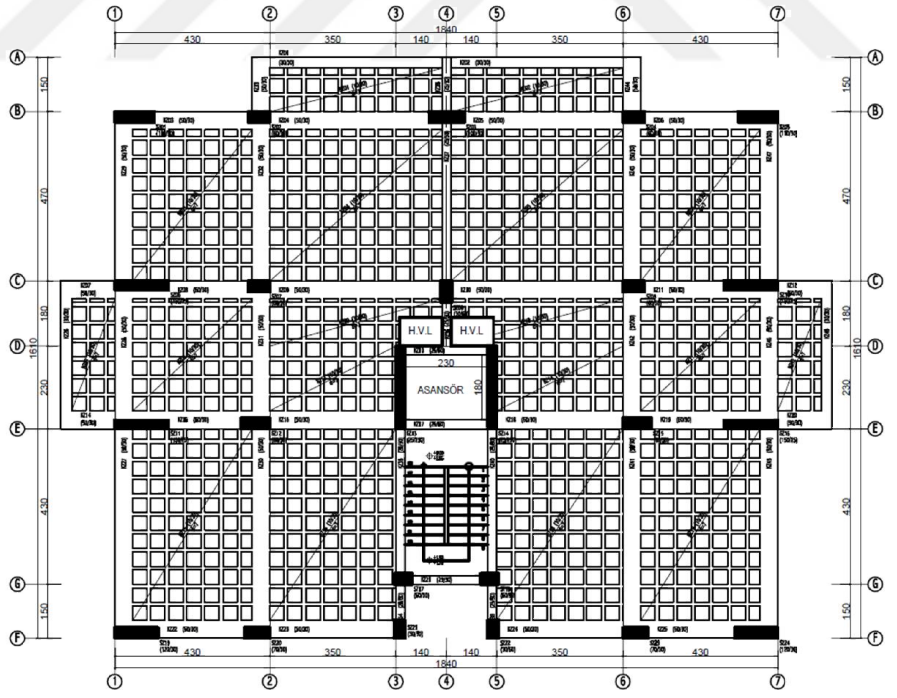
Durum 1'e ait plak döşeme kalıp planı
